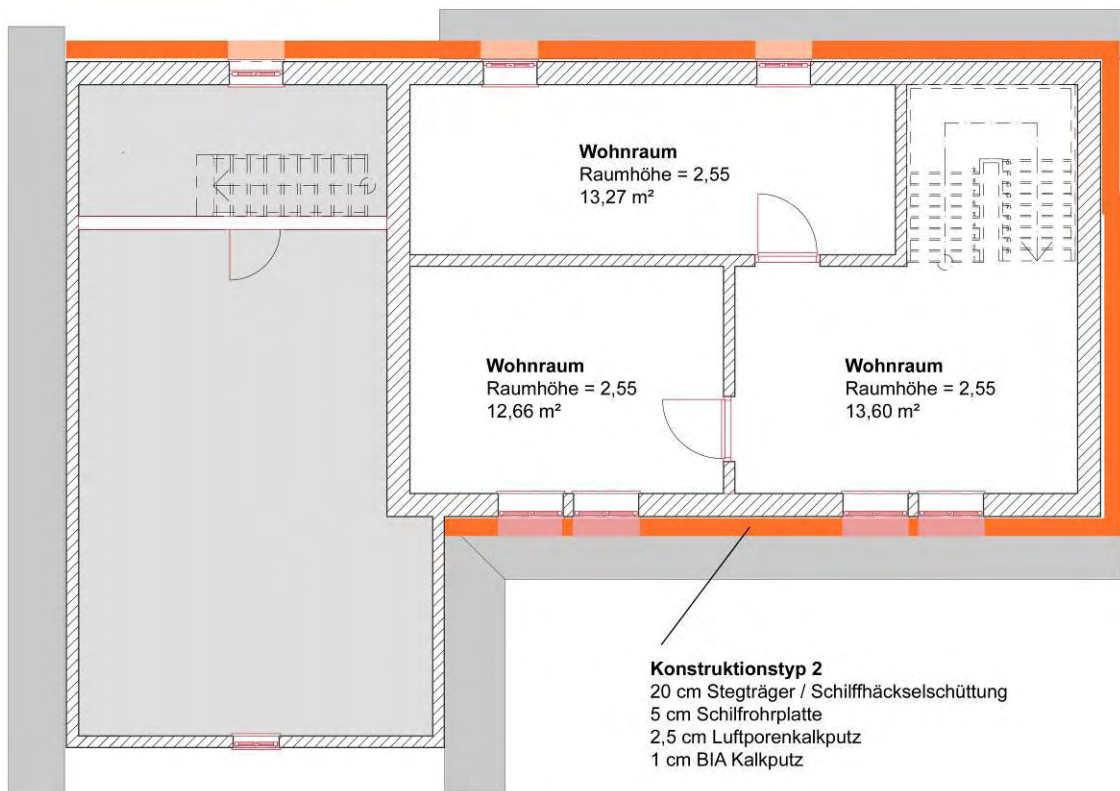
Grundrisschema OG für Sanierungsvariante „Außendämmung“
